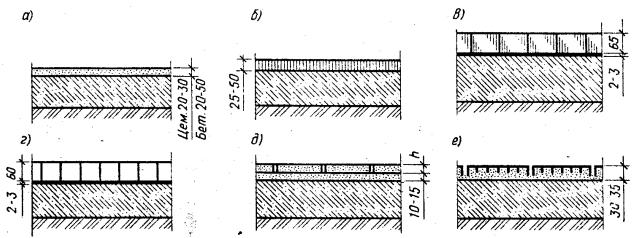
Полы, применяемые в промышленных зданиях: а — бетонный; б — асфальтобетонный; в — кирпичный; г — торцовый; д — плиточный; е — металлический
